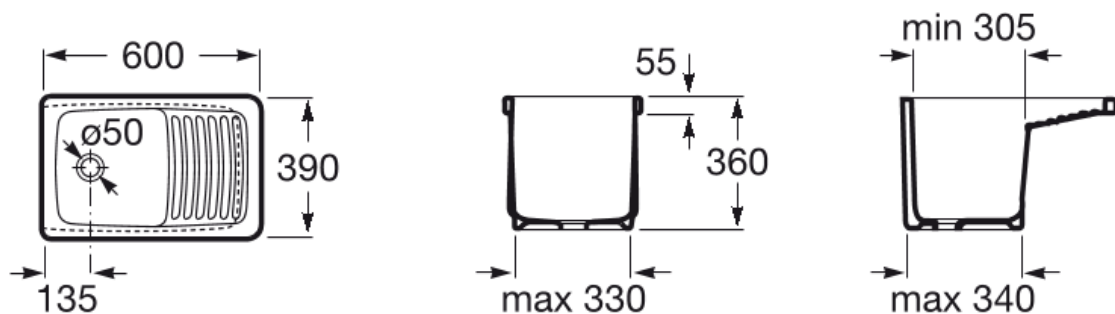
Dimensiones de la pila seleccionada para la instalación de bombeo (Fuente: Roca)
